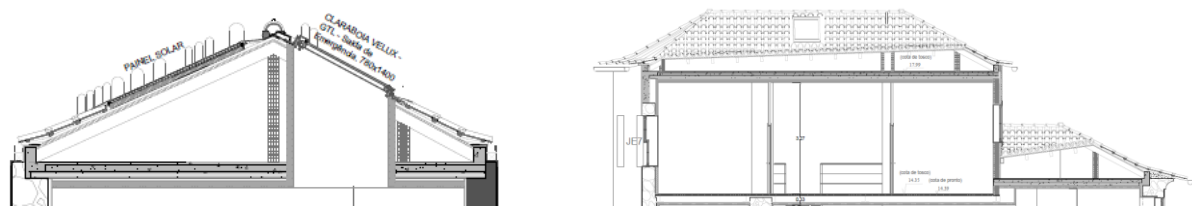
Pormenor construtivo do pavimento 5 [17]
